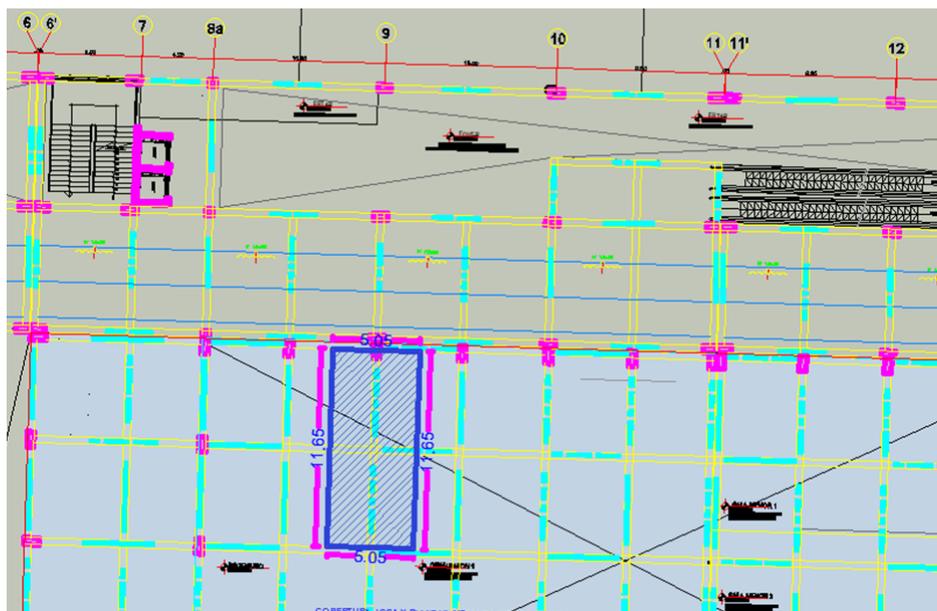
Pre – dimensionamiento de Vigas Sector Convenciones
